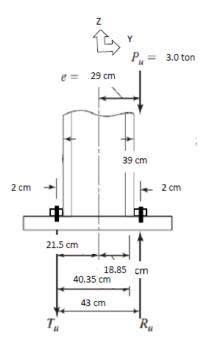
Ubicación de las fuerzas de compresión y tensión sobre la plancha
